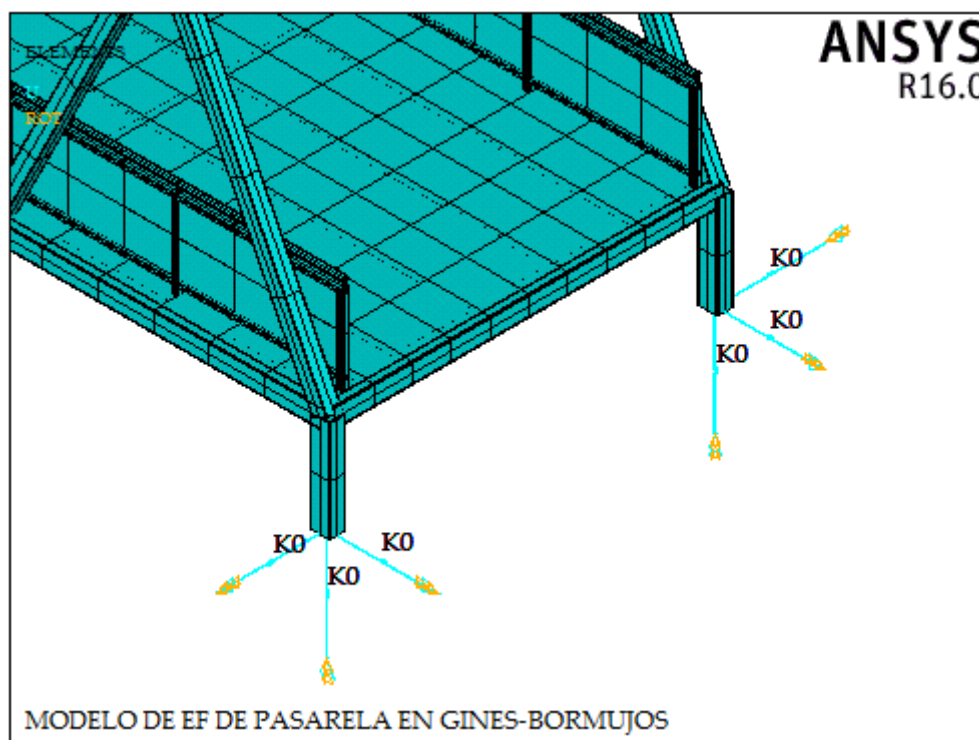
Detalle de la modelización de la rigidez de los estribos.
